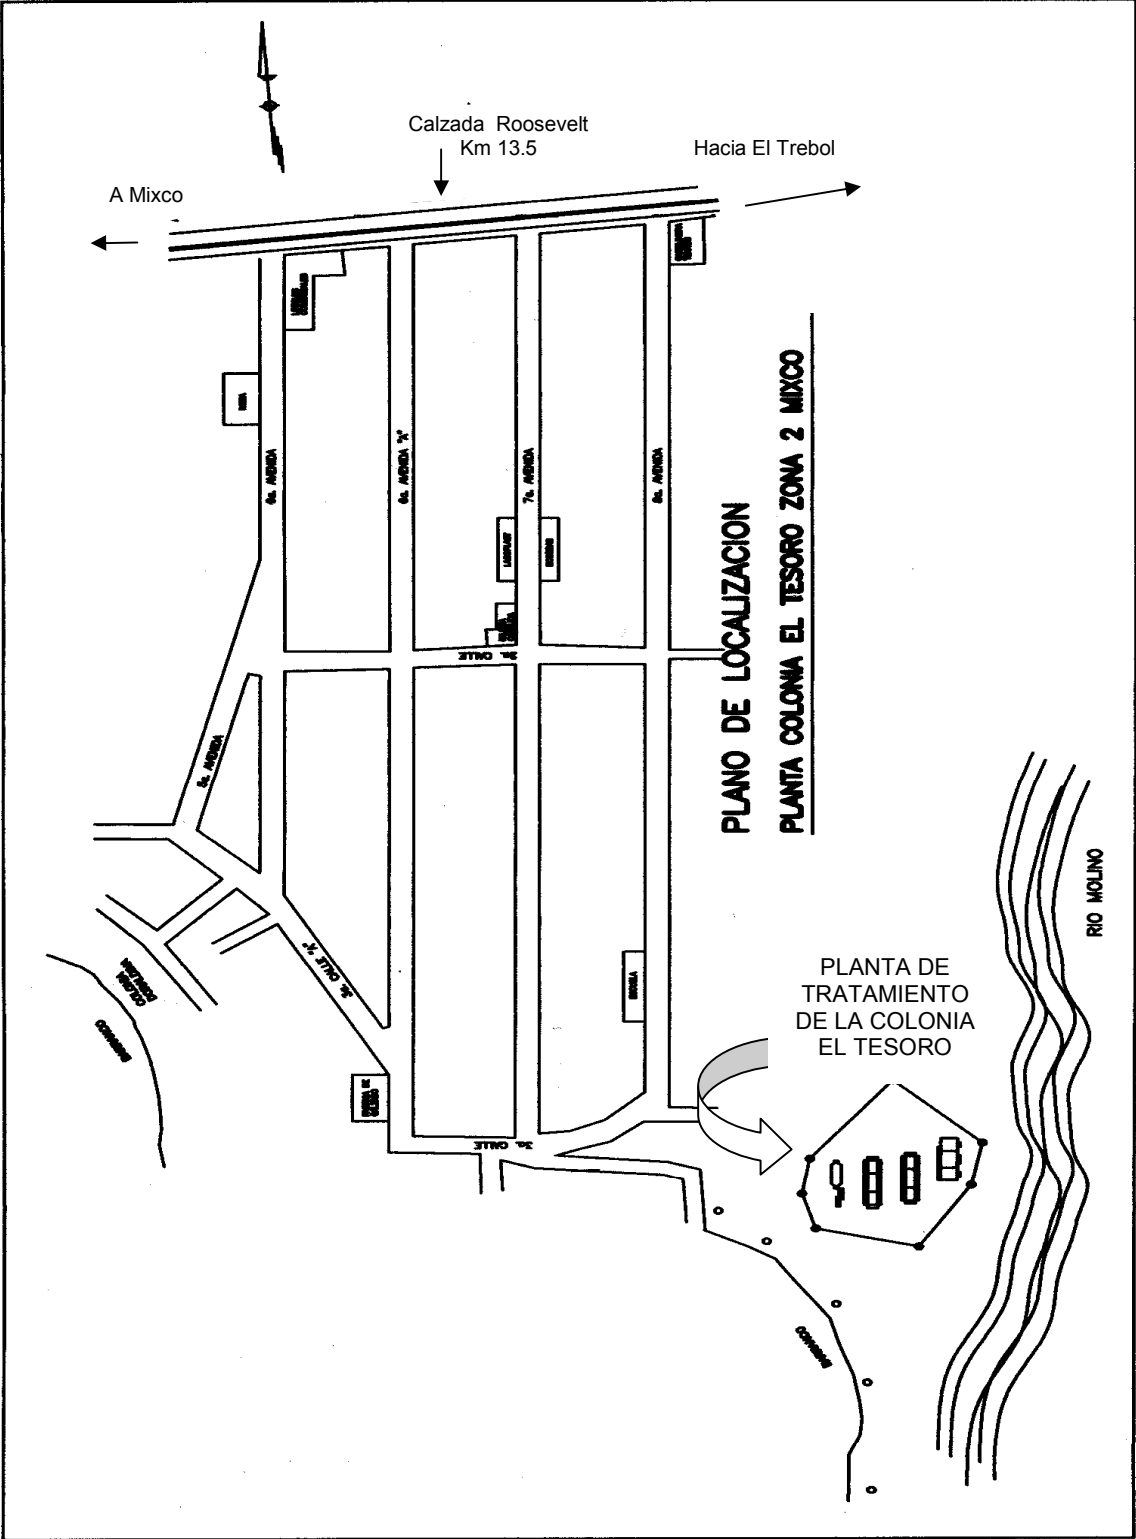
Plano de ubicación de las unidades de la planta de tratamiento de la colonia El Tesoro, Mixco
